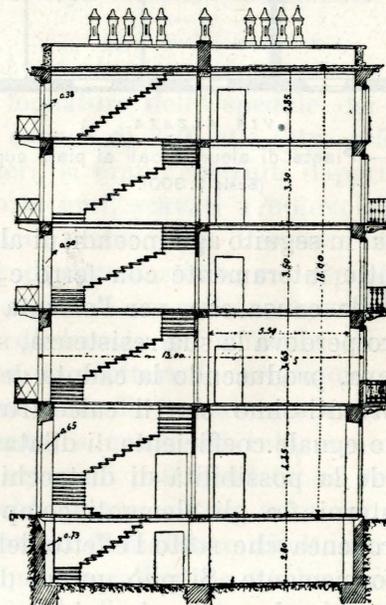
Sezione trasversale della casa Ing. E. Perondi con solai in cemento armato (Scala 1:300).
